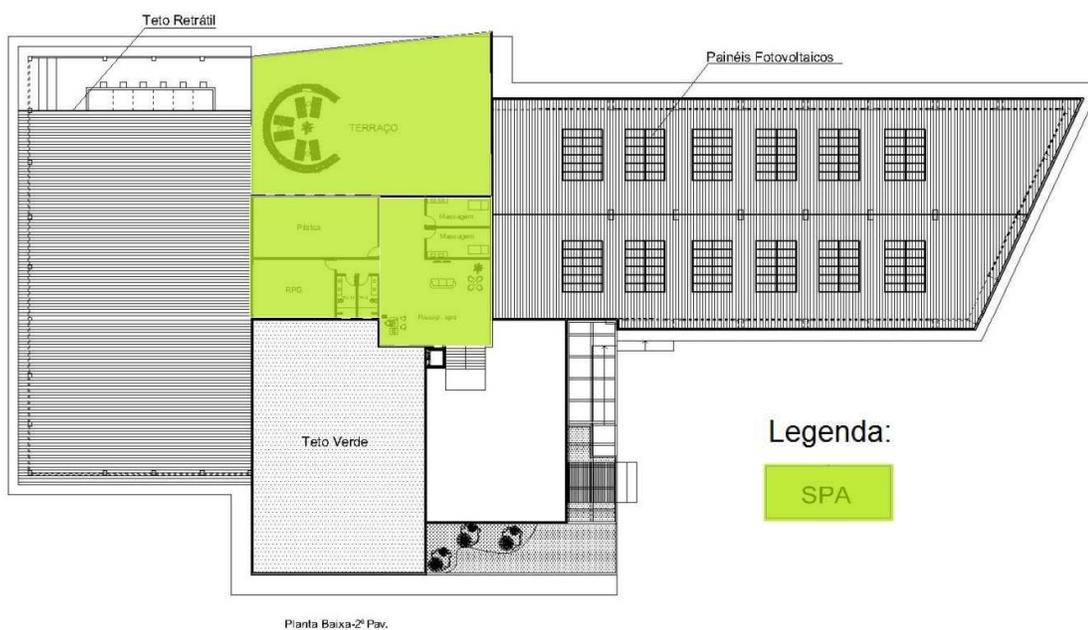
Setorização do Pavimento 02. Fonte: O Autor
